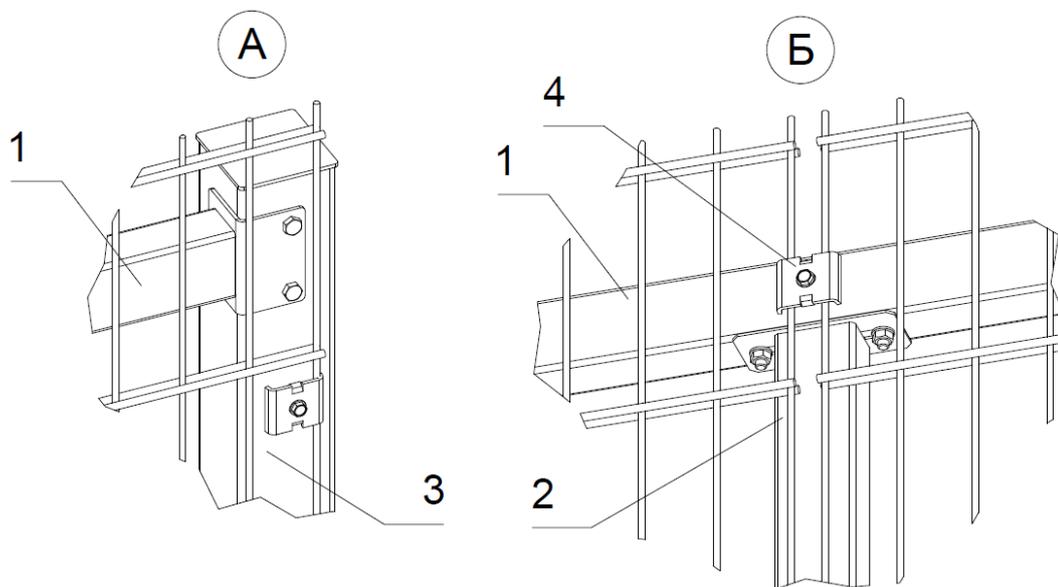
Узлы крепления перемычек (1 – горизонтальная перемычка, 2 – вертикальная перемычка, 3 – столб ворот, 4 – прижимная планка ПП.40.30 с саморезом)
